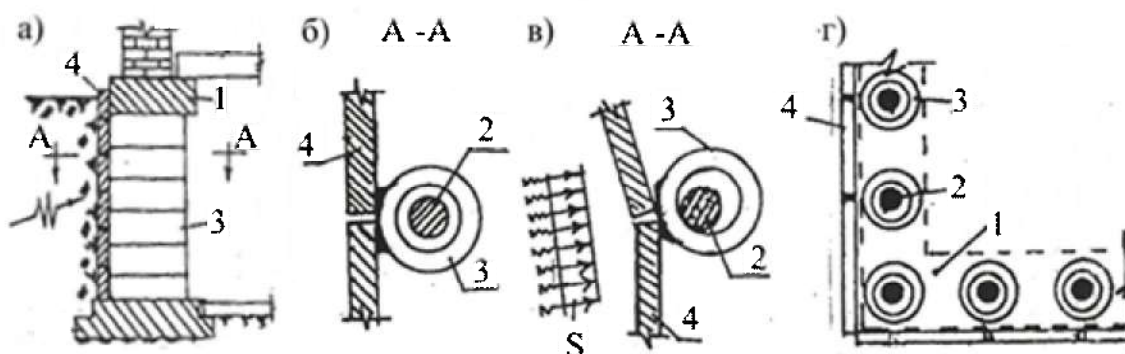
Комплексные конструкции сейсмоизолируемых стен. а – общий вид фундамента с сейсмоизолирующими элементами (фрагмент); б – разрез по А-А, до деформации, в – разрез по А-А, после деформации; г – план расположения ростверка (пунктирная линия) и колонн с шайбой (фрагмент); 1 – ростверк; 2 – фундаментная колонна; 3 – опорная шайба; 4 – ограждающая стена
